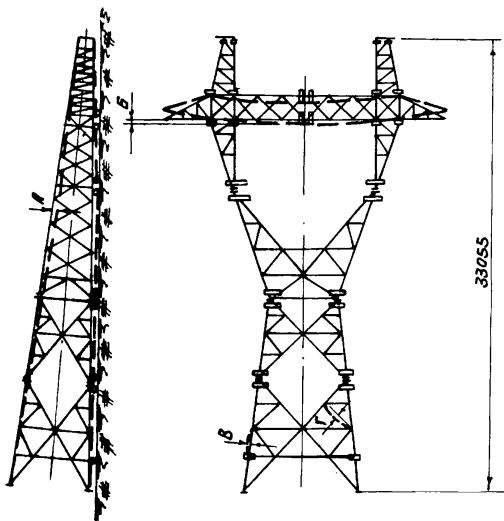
Допуски на сборку стальных опор ВЛ-500кВ
